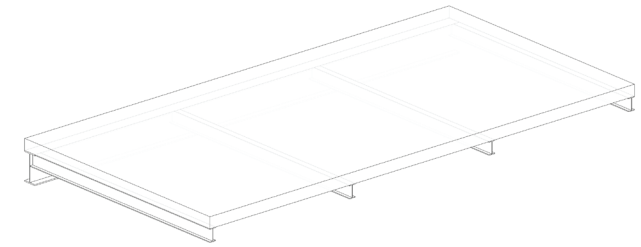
Vista assometrica del solaio in acciaio e legno; Fonte: elaborazione personale;
